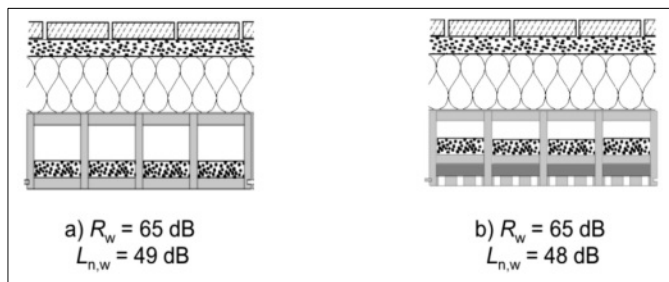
Flachdächer aus Massivholz-Kastenelementen, EPS-Aufdachdämmung, Dachabdichtung und Betonplatten im Kiesbett:
